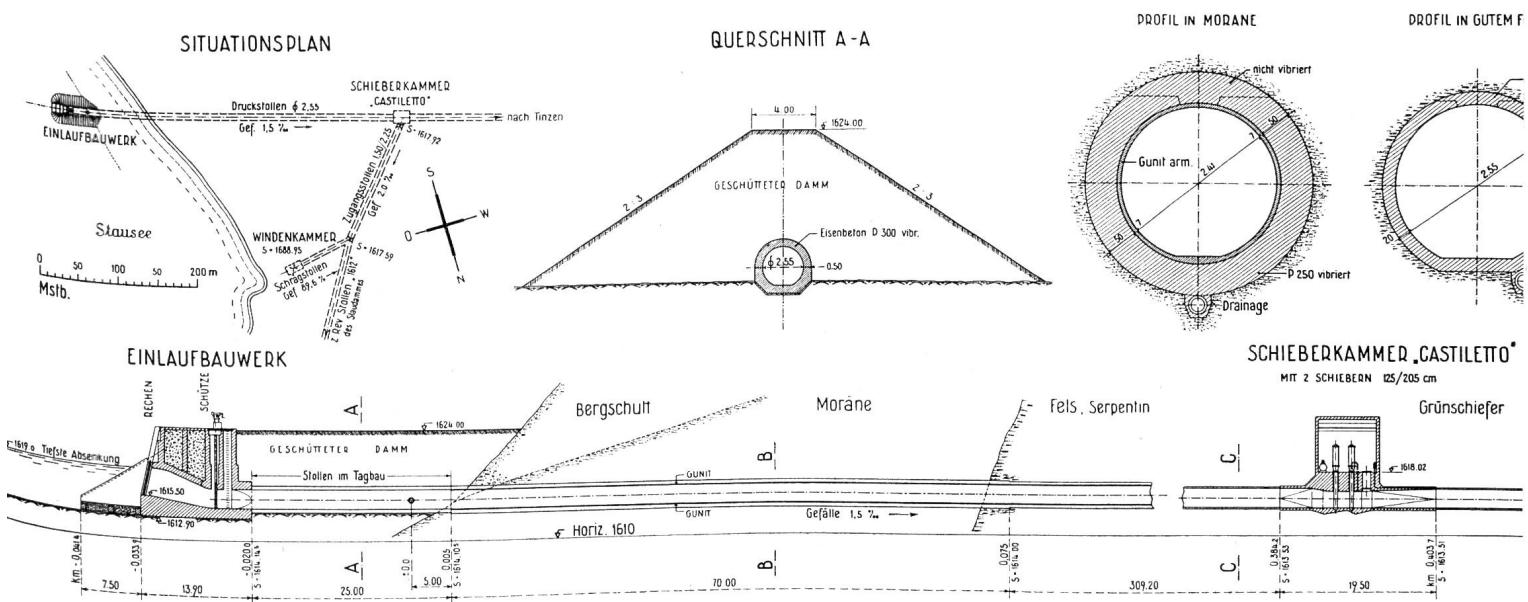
Druckstollen, Stolleneinlauf Castiletto
